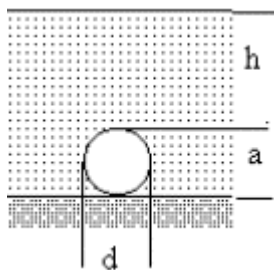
Схема к расчету давления грунта на трубу под насыпью
